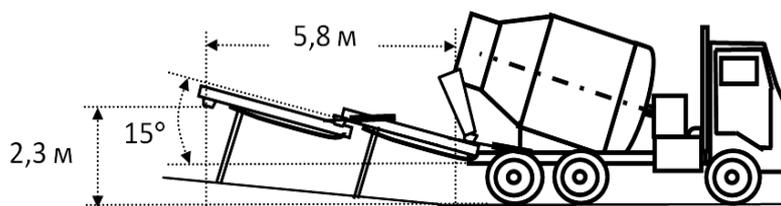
Схема длины, высоты и угла подъема при разгрузке бетона на строительной площадке с помощью винтовых шнеков на разработанном автобетоносмесителе (иллюстрация автора)
